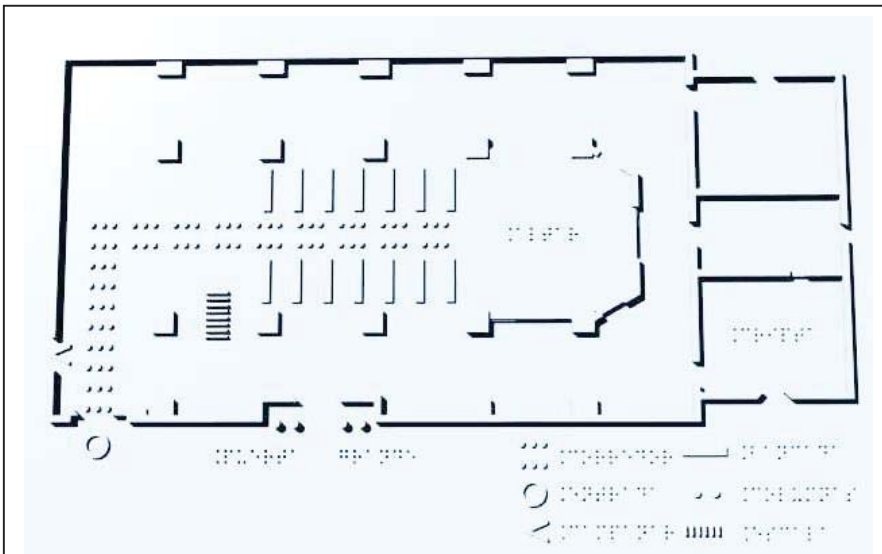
Modelado en 3D del plano de planta con leyenda en código de lecto-escritura braille. . Fuente: J.Gual
